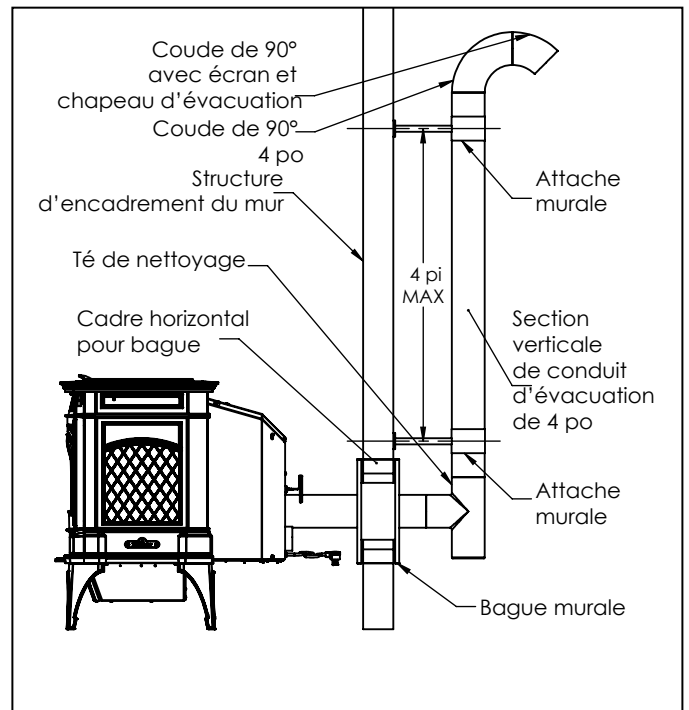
Ventilation à travers un mur avec un évent horizontal
